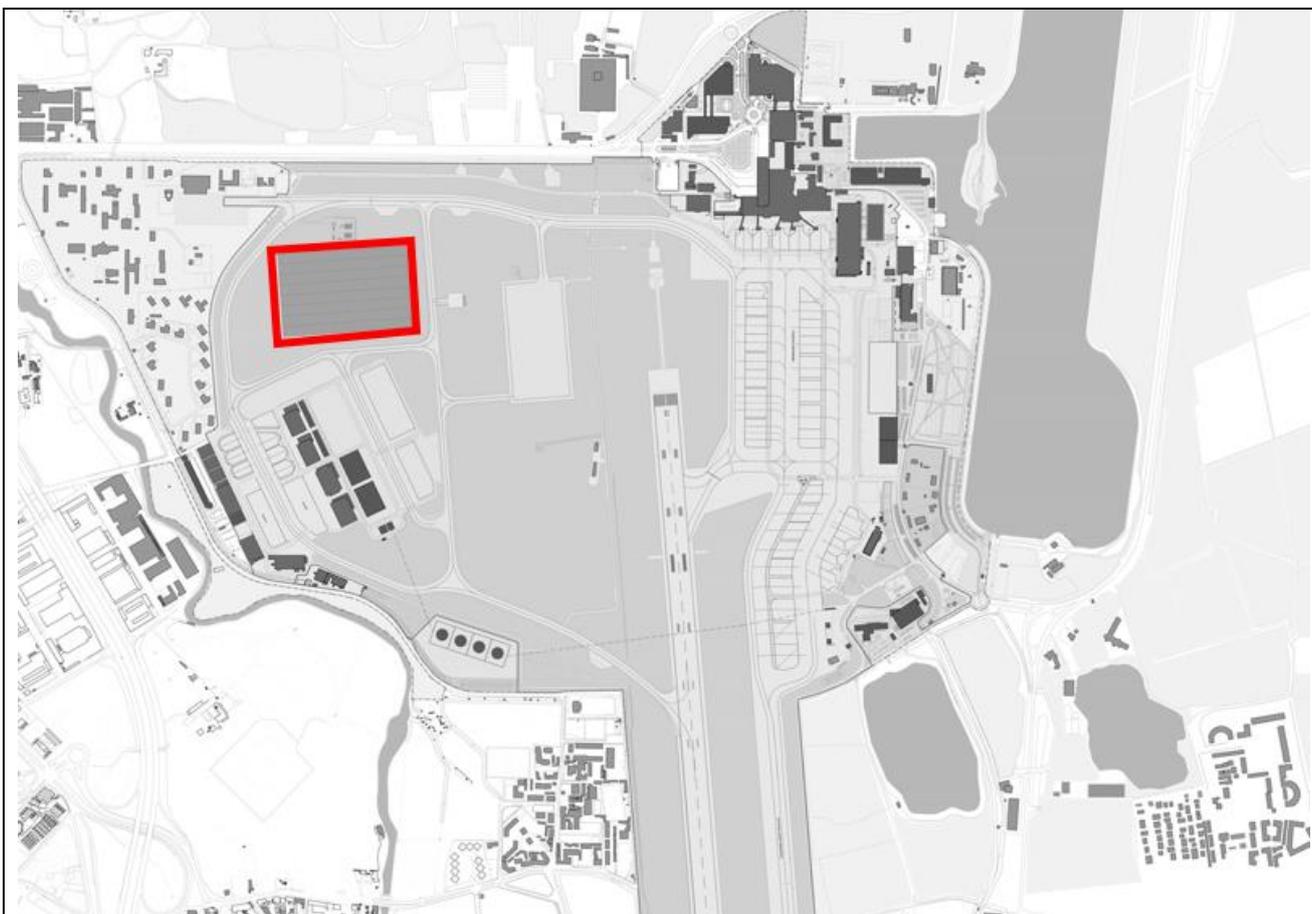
Stralcio planimetrico che individua l'ambito di intervento del nuovo parco fotovoltaico
